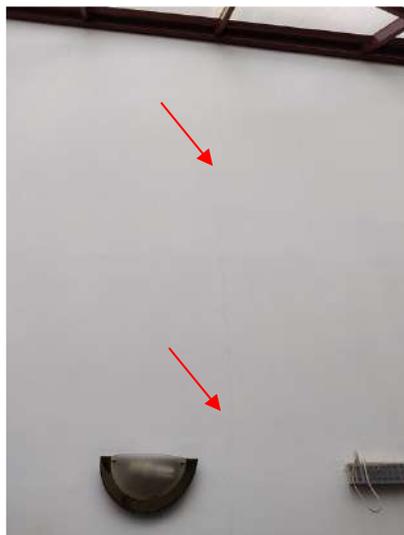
Hall Principal – Fissura vertical na parede, lado esquerdo do Auditório
